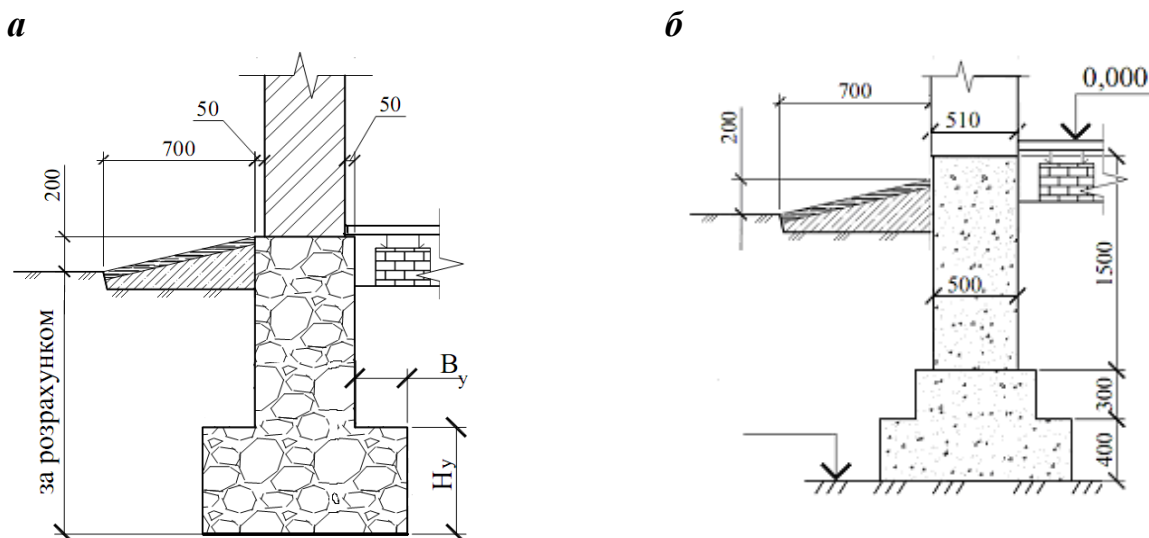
Стрічкові монолітні фундаменти під цегляну стіну: а – бутовий фундамент; б – бутобетонний
